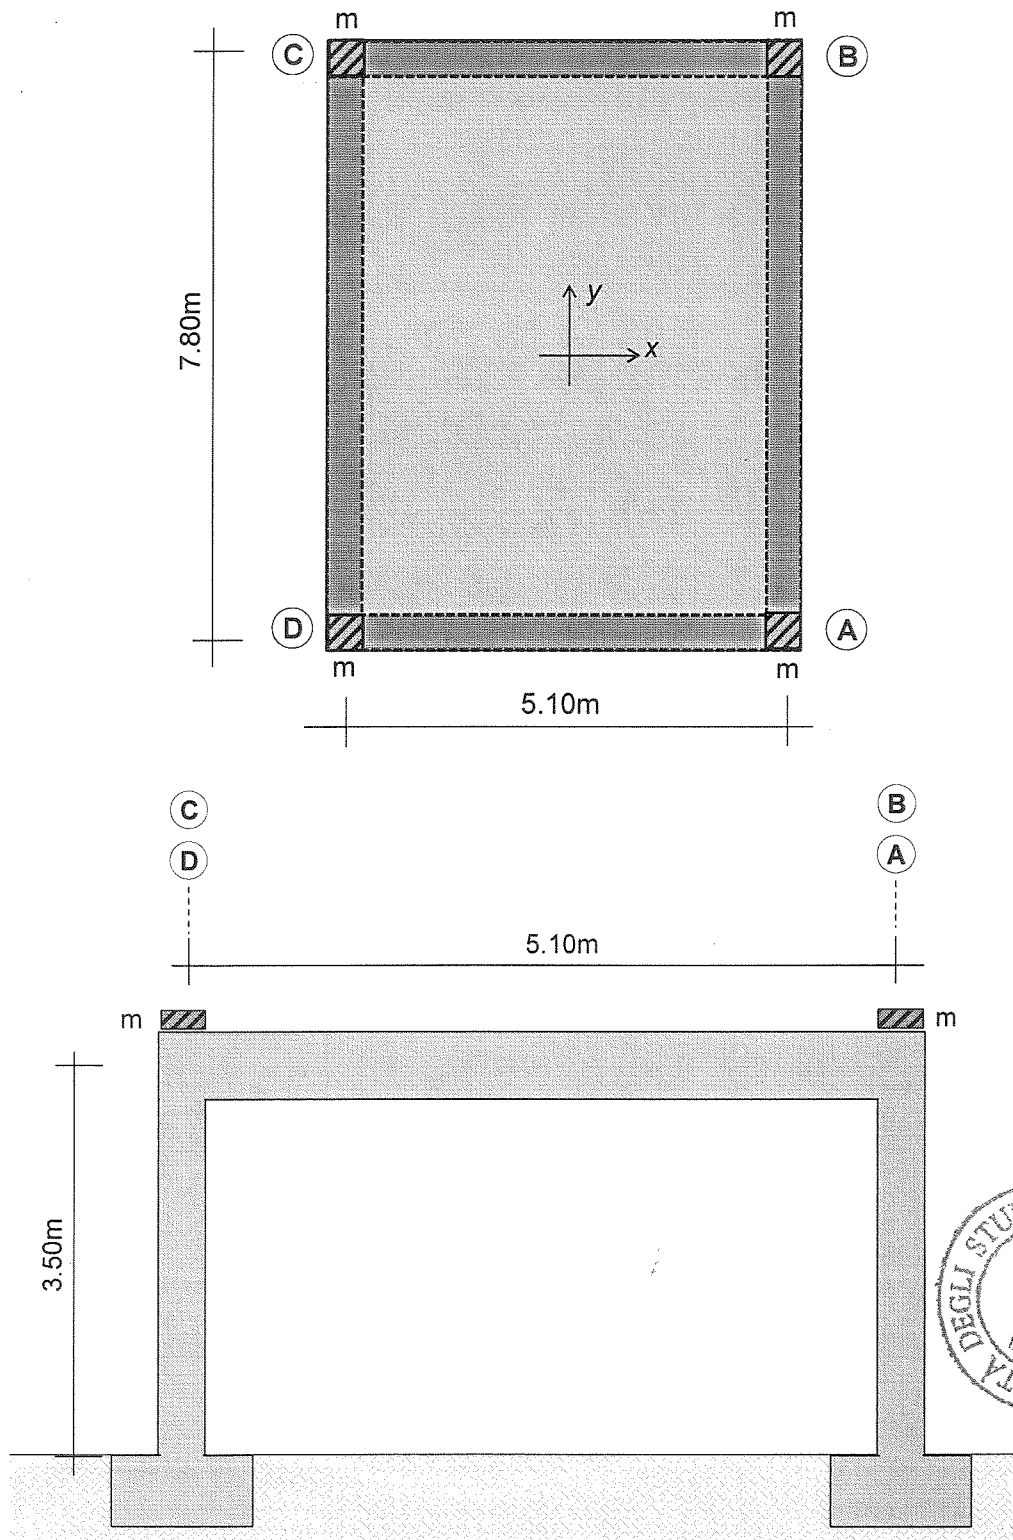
pianta (in alto) e prospetto (in basso) della struttura da progettare.
